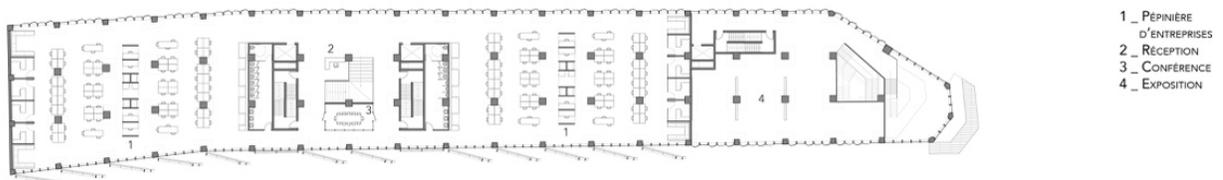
\_ Plan du 1<sup>er</sup> Étage
